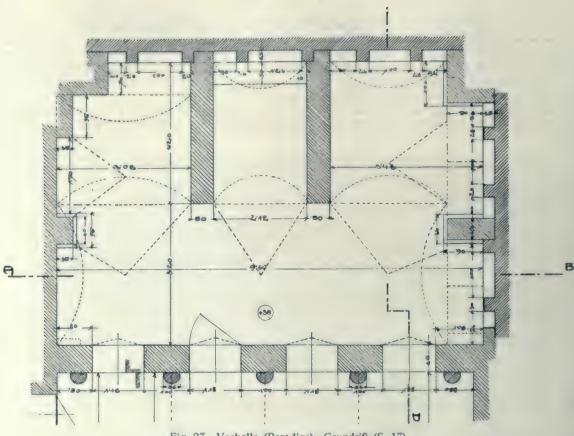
· Vorhalle (Paradies), Grundriß (S. 17)
